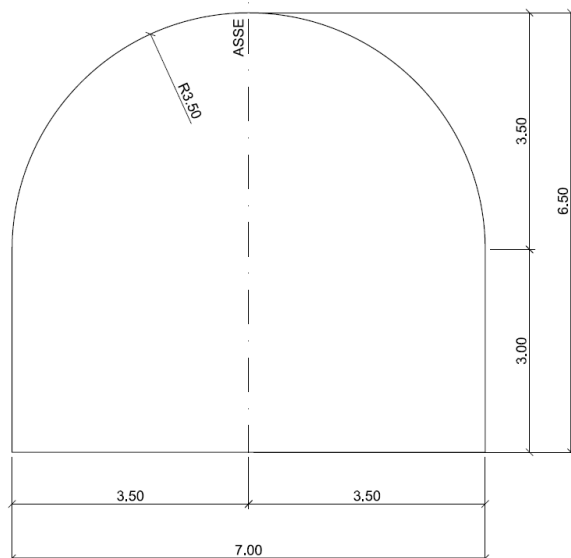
Sezione analizzata Tipo 1 Galleria Di Accesso Al Pozzo Piezometrico Di Monte
